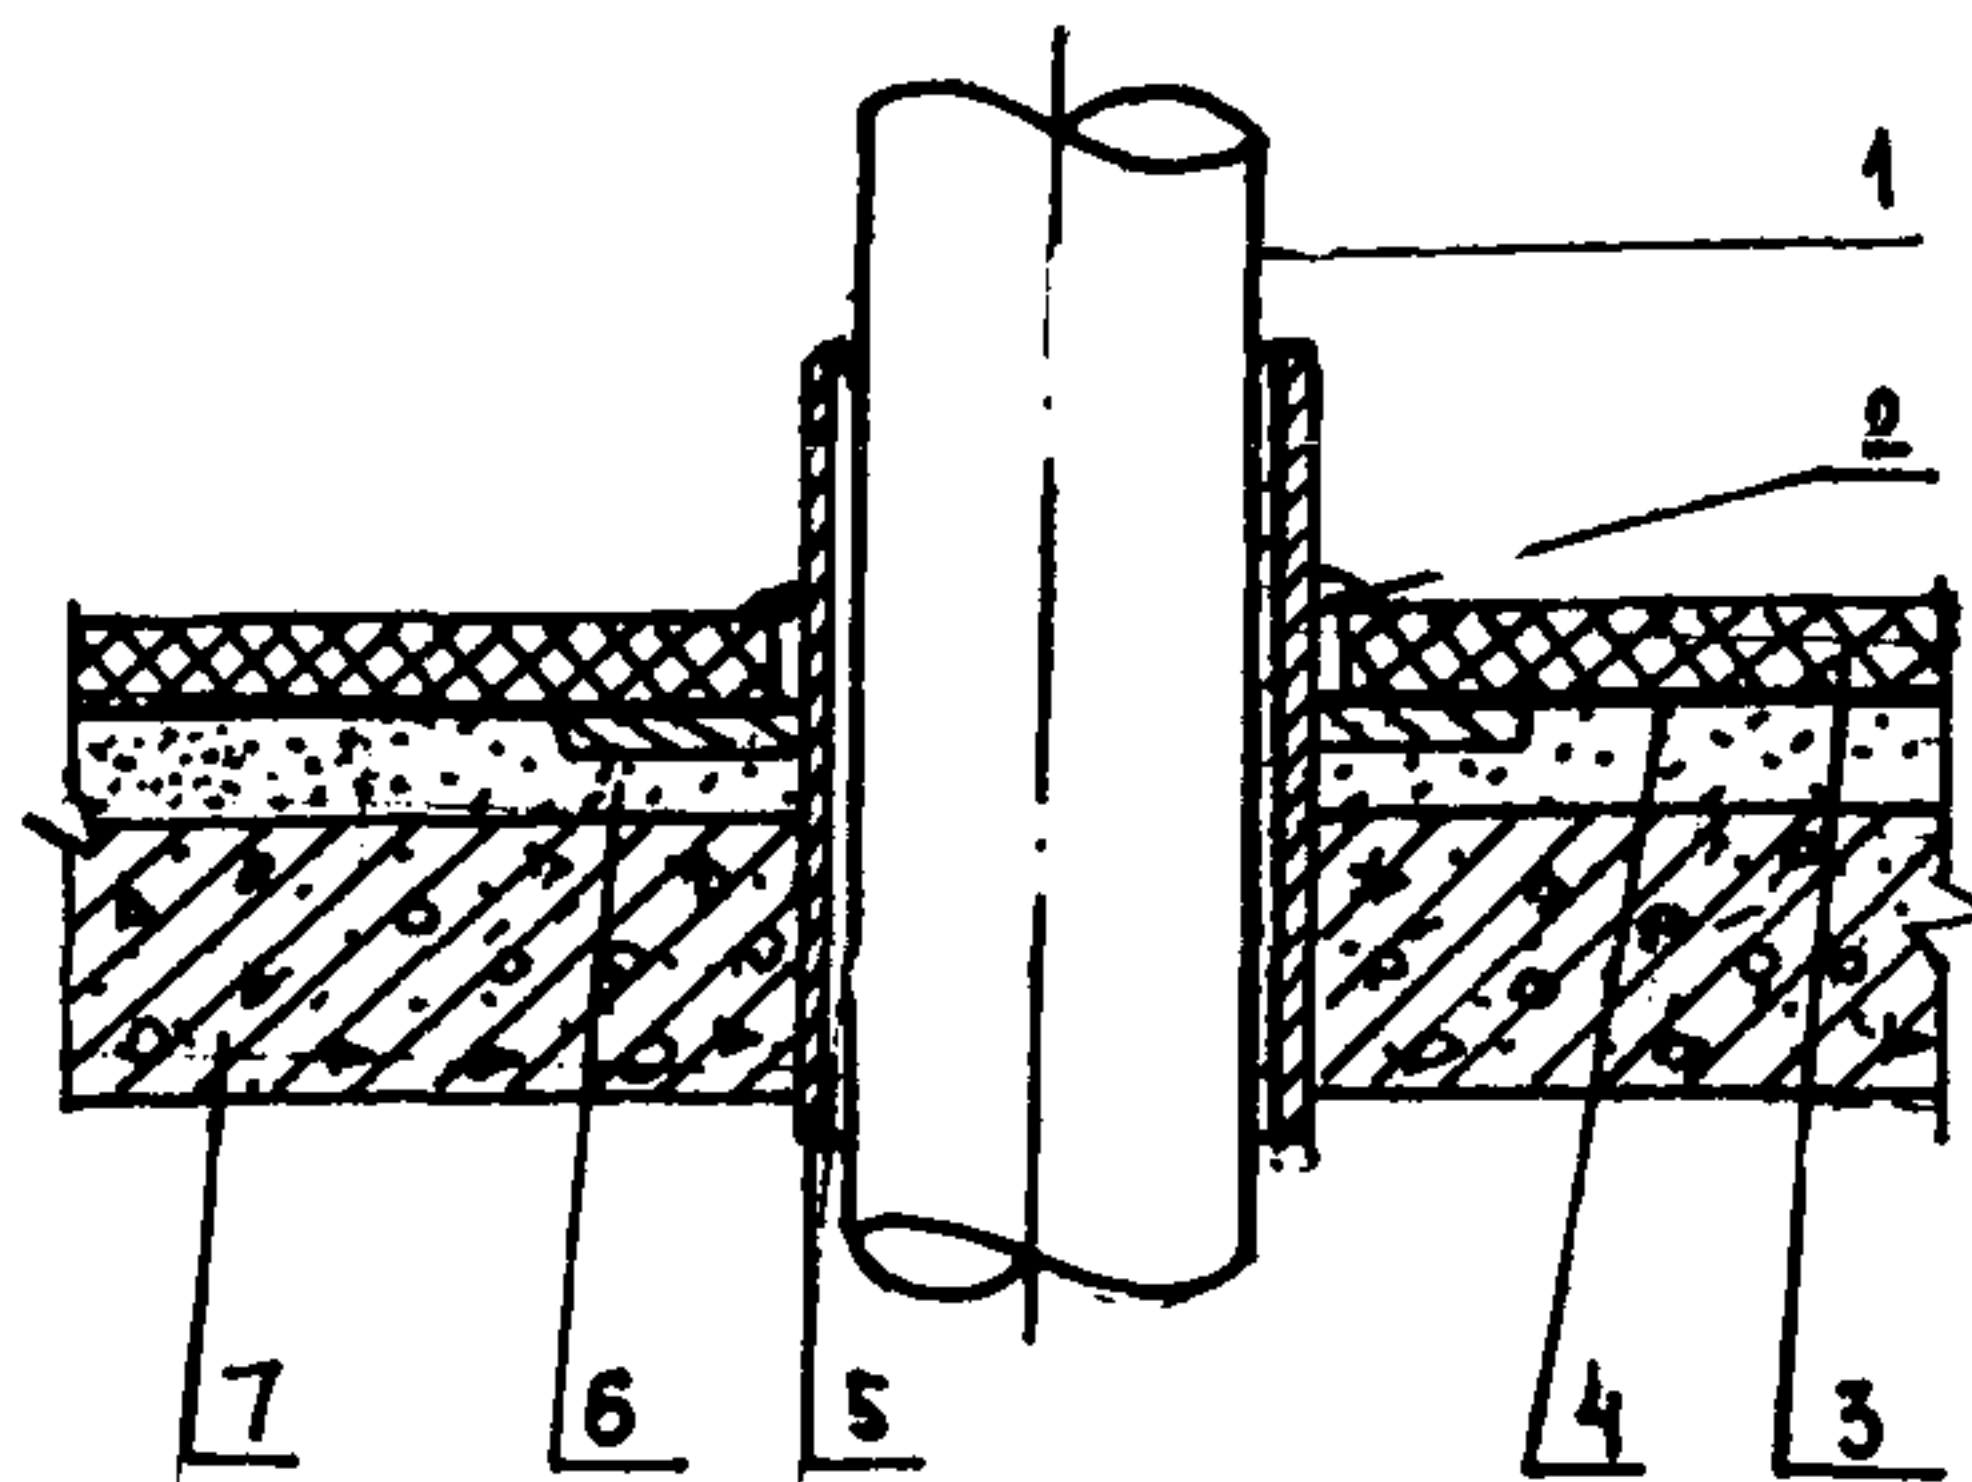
Оформление проема в перекрытии для технологического трубопровода
